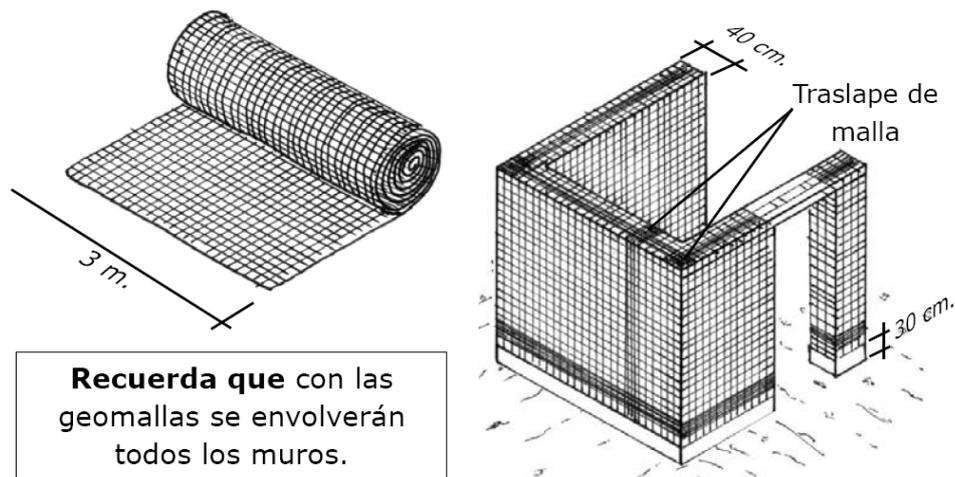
Ejemplo de esquema de construcción de vivienda de adobe reforzado con geomalla recogido en las cartillas editadas para la difusión de la técnica tras el terremoto de Pisco de 2007 (Vargas et al, 2007)
